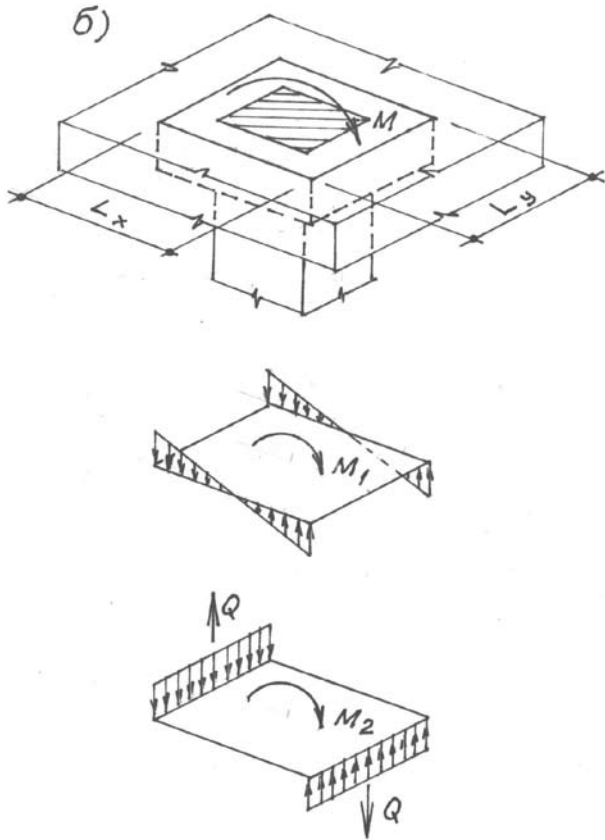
Эпюры касательных напряжений в бетоне по расчетному контуру продавливания при действии момента M .
